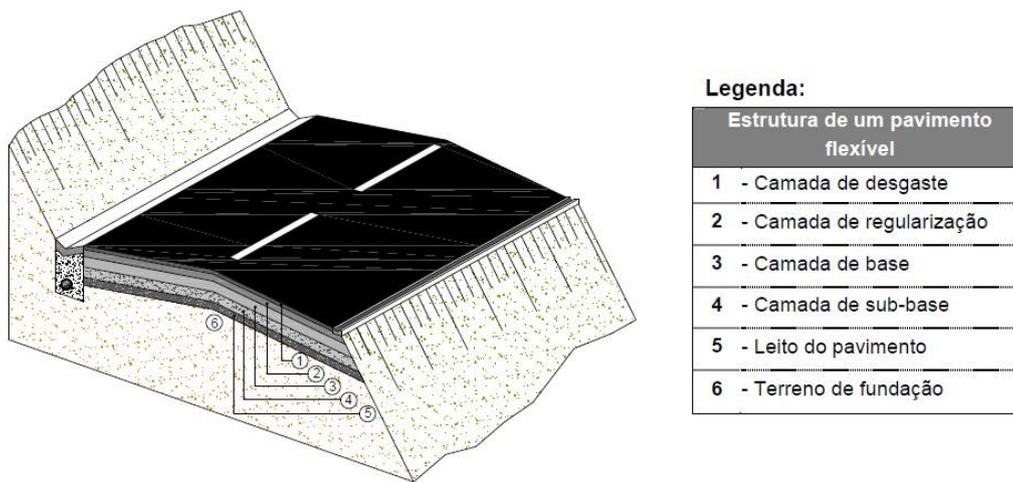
Diagrama explicativo da constituição de um pavimento flexível
